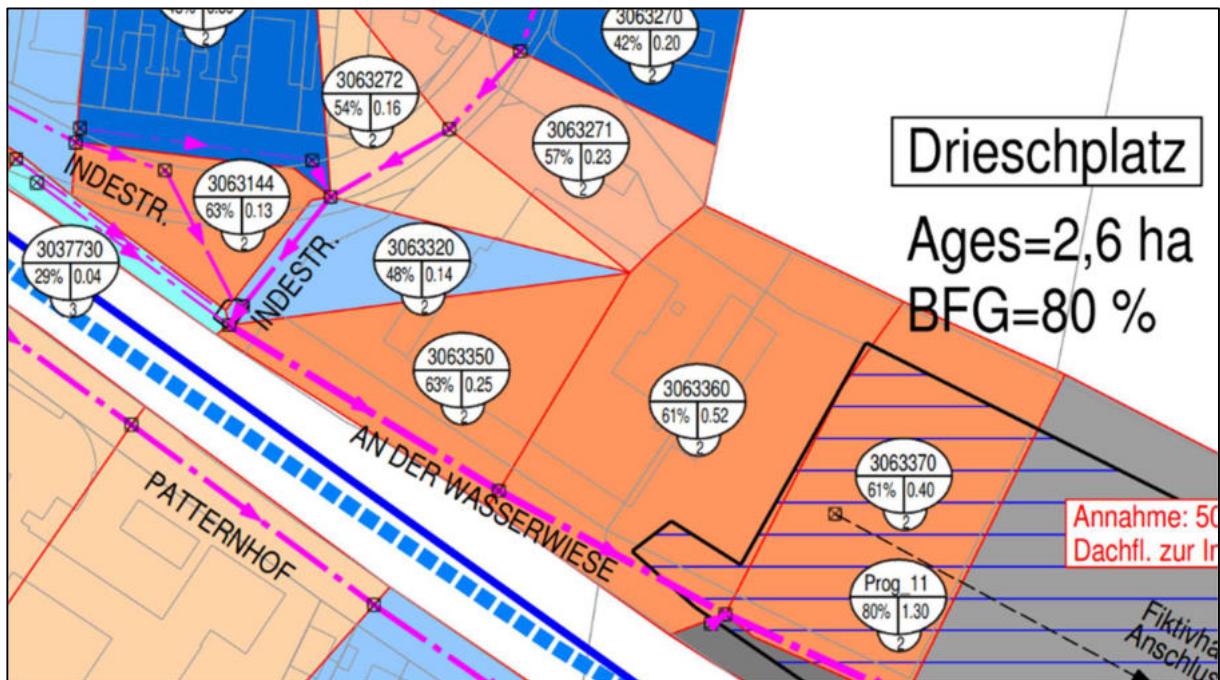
Ausschnitt Generalentwässerungsplan, Stadt Eschweiler
